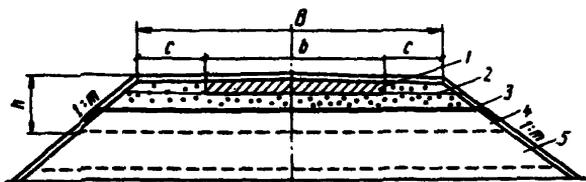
Конструкция насыпи из грунтов повышенной влажности с разделяющей прослойкой из геотекстиля: 1-покрытие, устроенное на первой стадии строительства дорожной одежды переходного типа; 2-морозозащитный (дренирующий) слой; 3-рабочий слой из грунта с $K_u=0,95$; 4-геотекстильная разделяющая и армирующая прослойки; 5-тело насыпи из грунта повышенной влажности с $K_u \geq 0,93$
